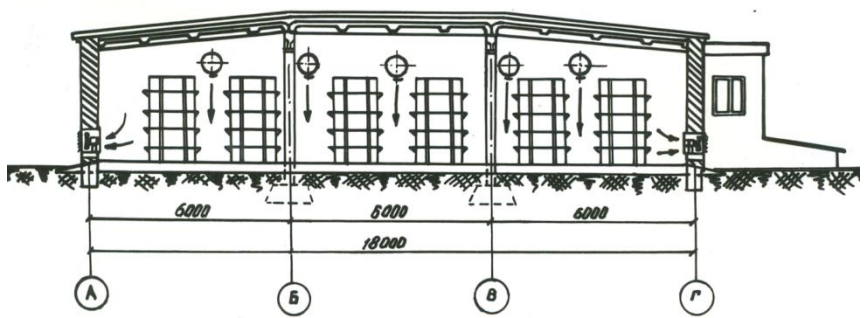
Разрез помещения птичника при вентилировании здания с помощью пленочных воздуховодов уложенных над проходами между рядами клеточных батарей
